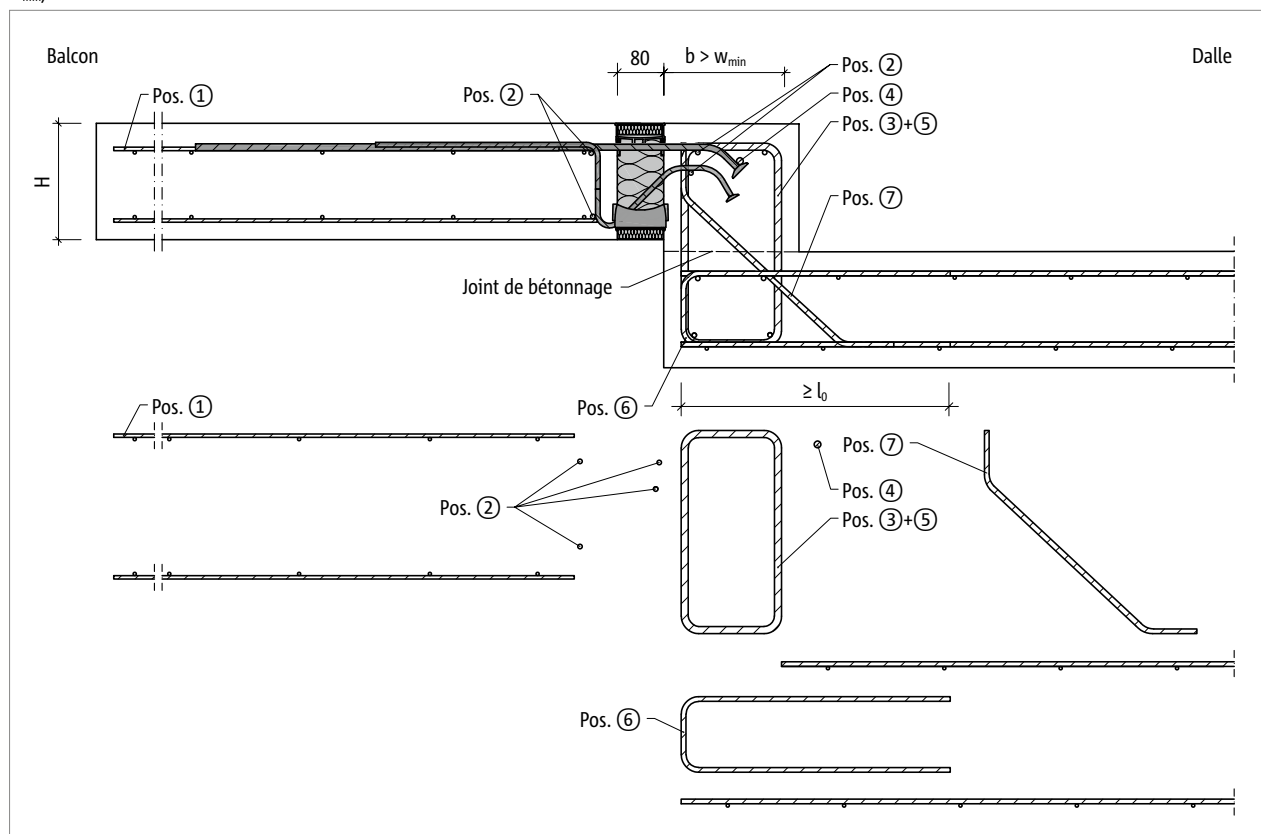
Schöck Isokorb® T type K-O-F : Renforcement sur site pour balcon avec décalage vers le haut avec une dimension plus grande du composant ($w_{pres} > w_{min}$)
